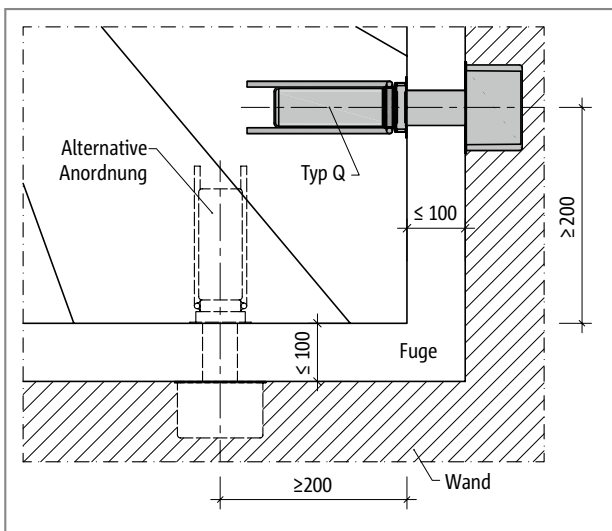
Schöck Tronsole® Typ Q: Elementanordnung, Detail B
